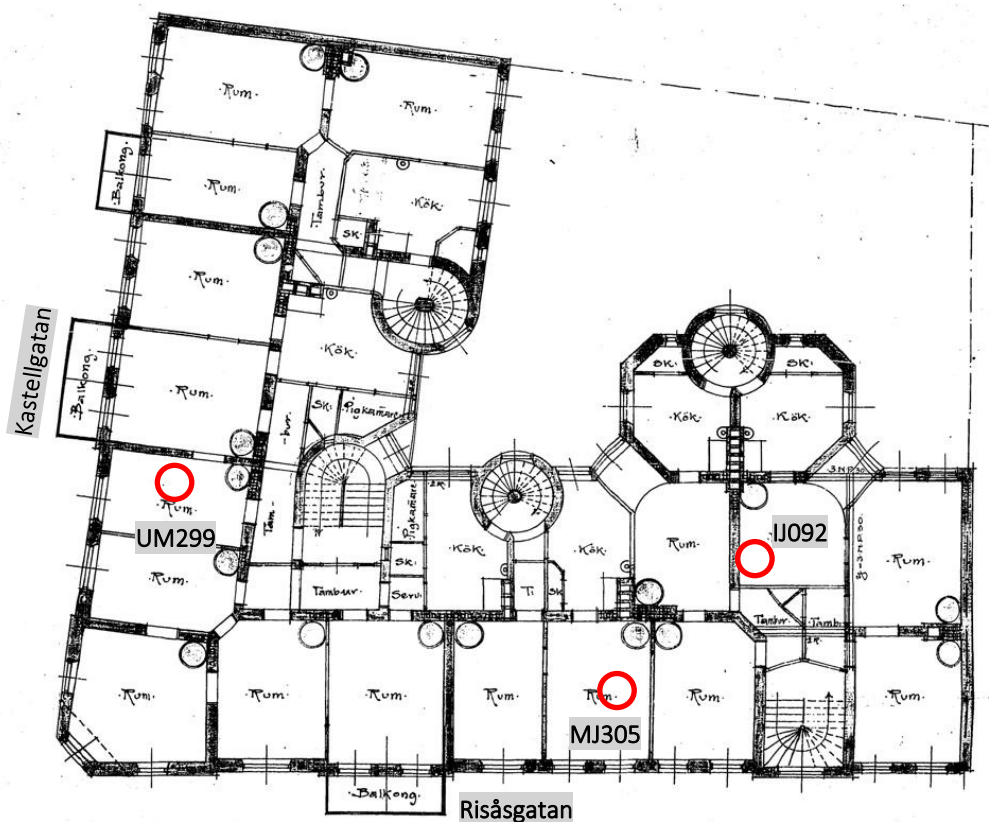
Provpunkternas placering på källarplan för porgas under bottenplattan.
